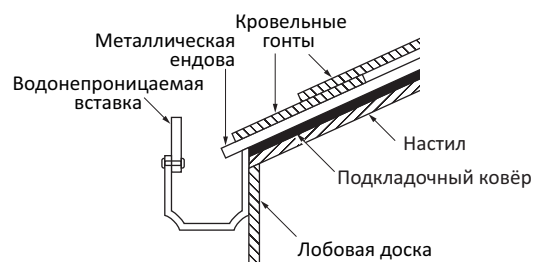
Подогнутый край – очень важная деталь гидроизоляции крыши.
